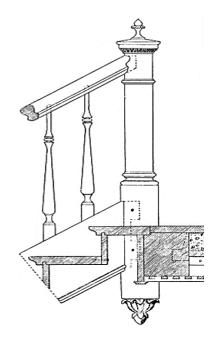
Деревянный столбик под монтаж перил, зажатый между тетивой и лестничной площадкой. Г.В. Кирштейн, 1899 г. [2] Fig. 9. A wooden post for mounting the handrail, sandwiched between
